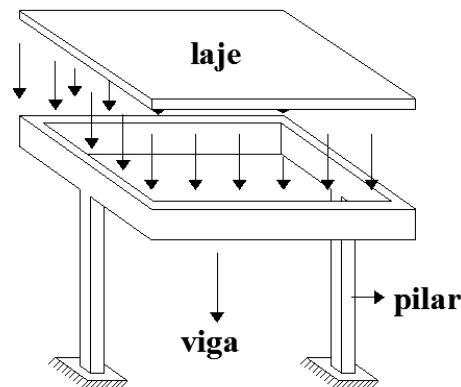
Laje maciça rectângular apoiada em quatro vigas e dois pilares
